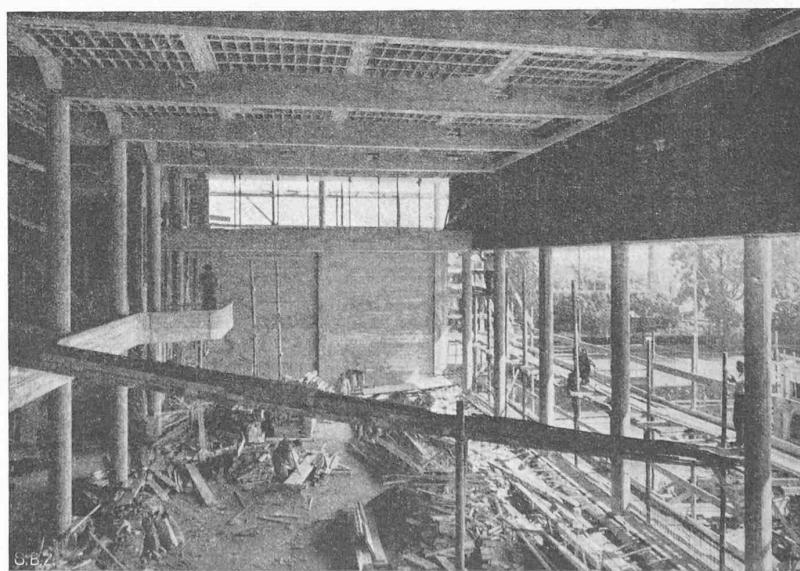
Foyertrakt im Eisenbeton-Rohbau (Seeseite rechts)
